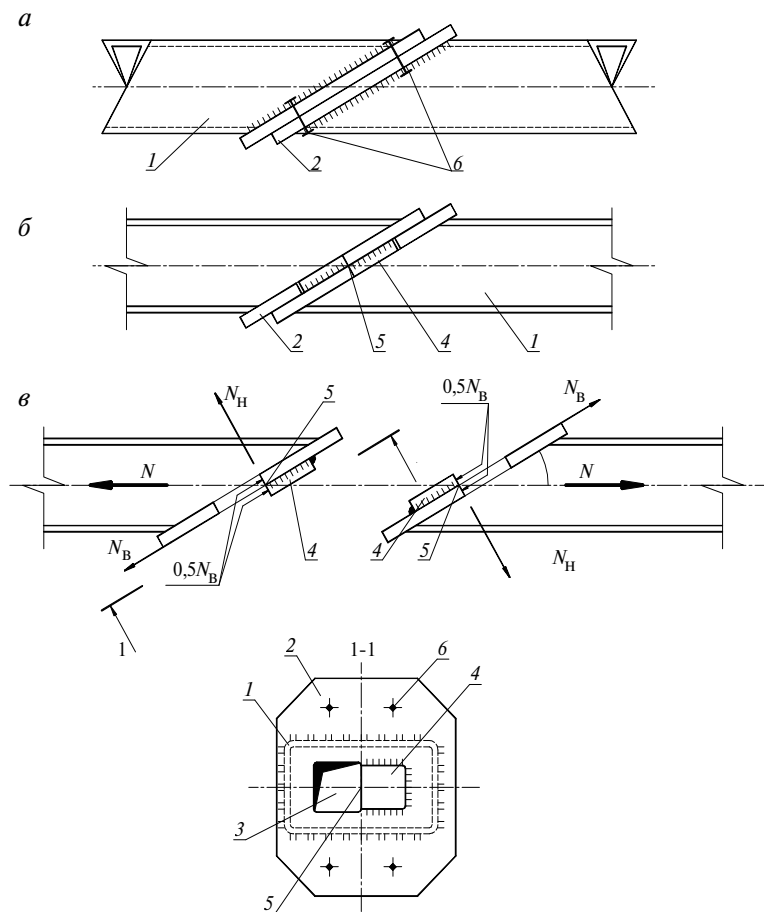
Стык нижнего пояса стропильной фермы со сварными фланцами из прокатного листа: *а* — вид сверху; *б* — сечение по оси стыка; *в* — разомкнутый стык и расчетная схема стыка: 1 — соединяемые элементы; 2 — фланец; 3 — отверстие во фланце; 4 — упор; 5 — центр стыка; 6 — стяжной болт
